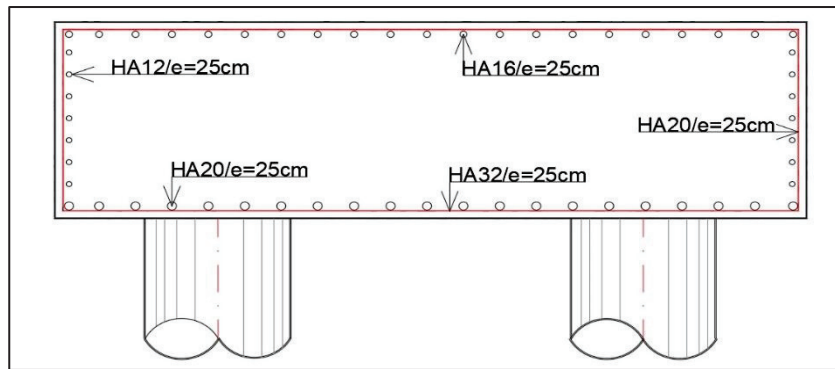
FERRAILLAGE DE LA SEMELLE.
